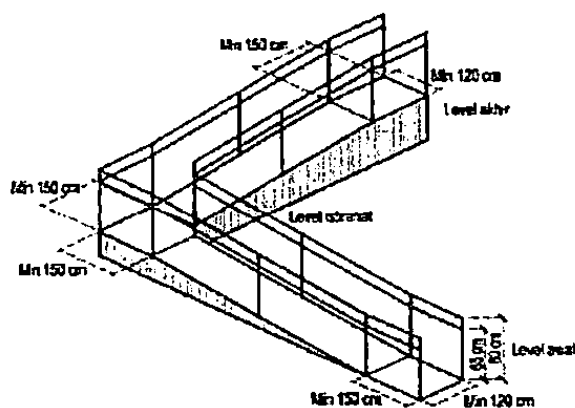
Ukuran dan Detail Penerapan Standar RAM
